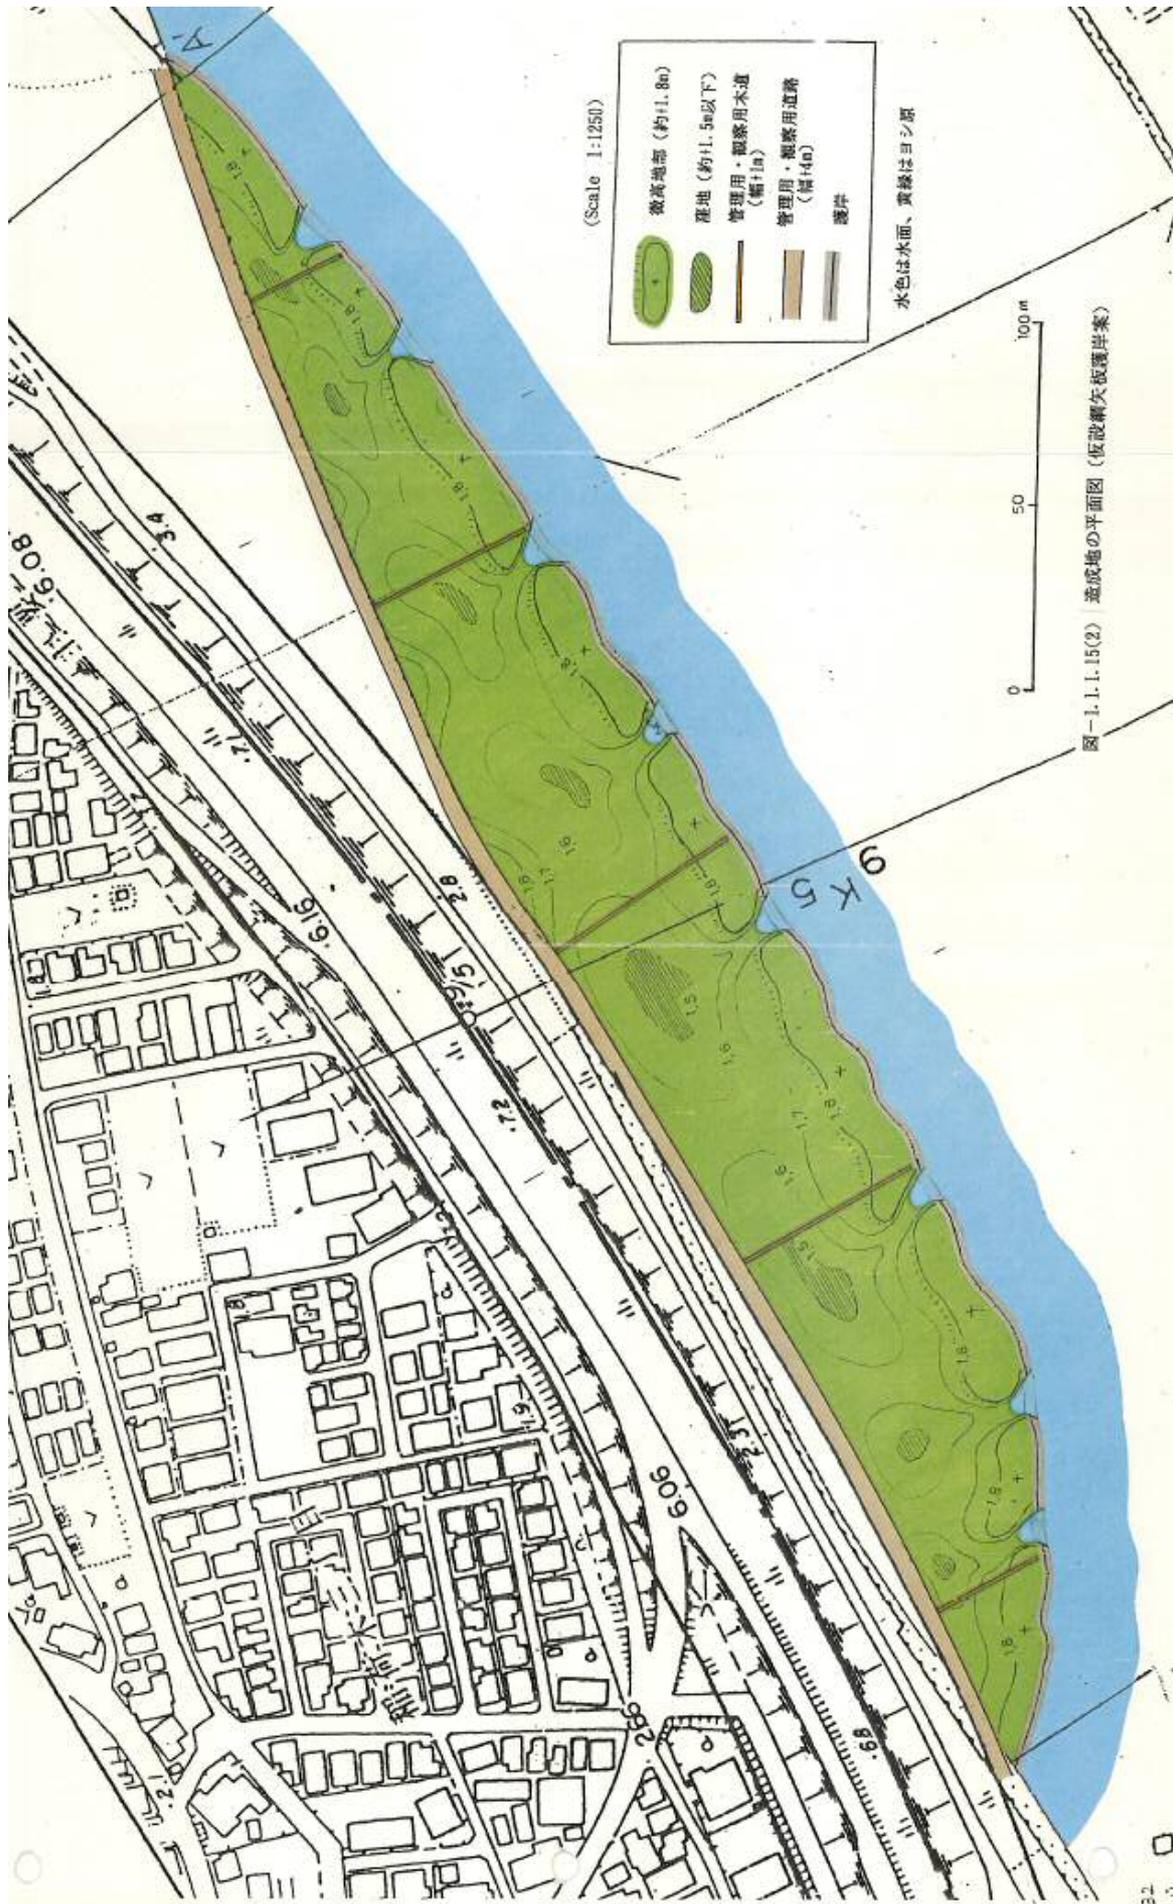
(2) 造成地の平面図 (仮設鋼矢板護岸案)
